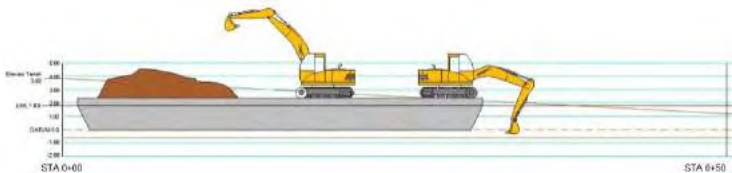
Potongan Melintang rencana jalannya ponton
